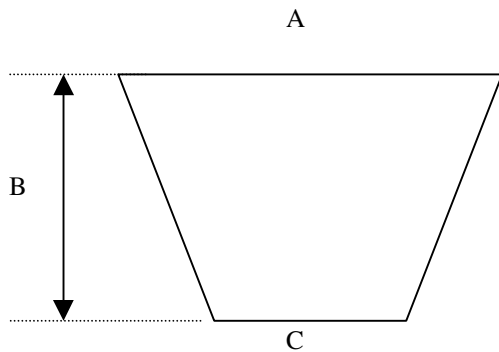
Desenho esquemático das barras em concreto ou madeira.
